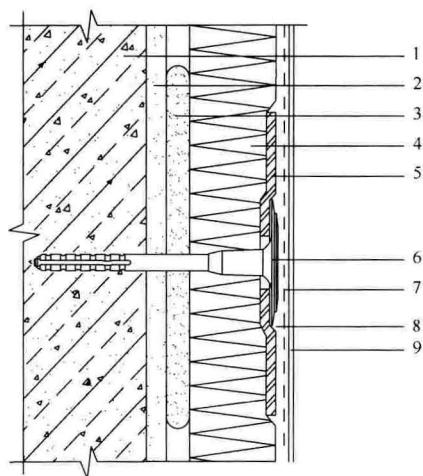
岩棉条锚盘压条单网构造示意
